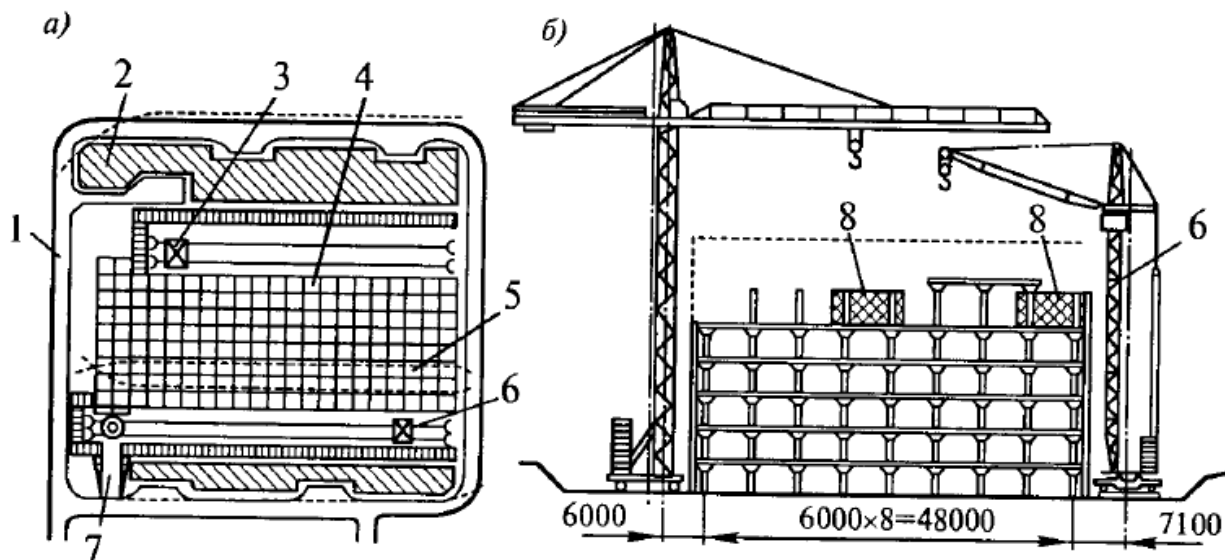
Схема организации монтажа безбалочного каркаса многоэтажного промышленного здания: а — план монтажной площадки; б — монтаж каркаса; 1 — автодорога; 2 — зона складирования; 3 — кран КБ-674, 4 — каркас здания; 5 — зона перемещения груза краном; 6 — кран КБ-573; 7 — съезд в котлован; 8 — групповой кондуктор.
